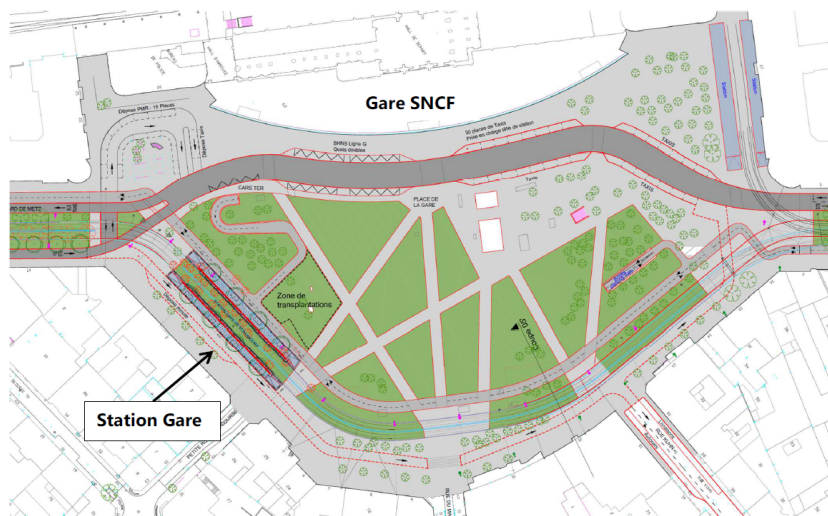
Plan de la place de la gare (source : AVP GETAS, 2023)
